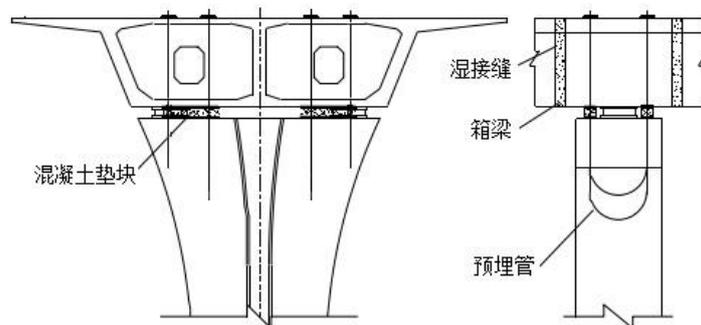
墩顶节段预制混凝土箱梁临时锚固示意图
